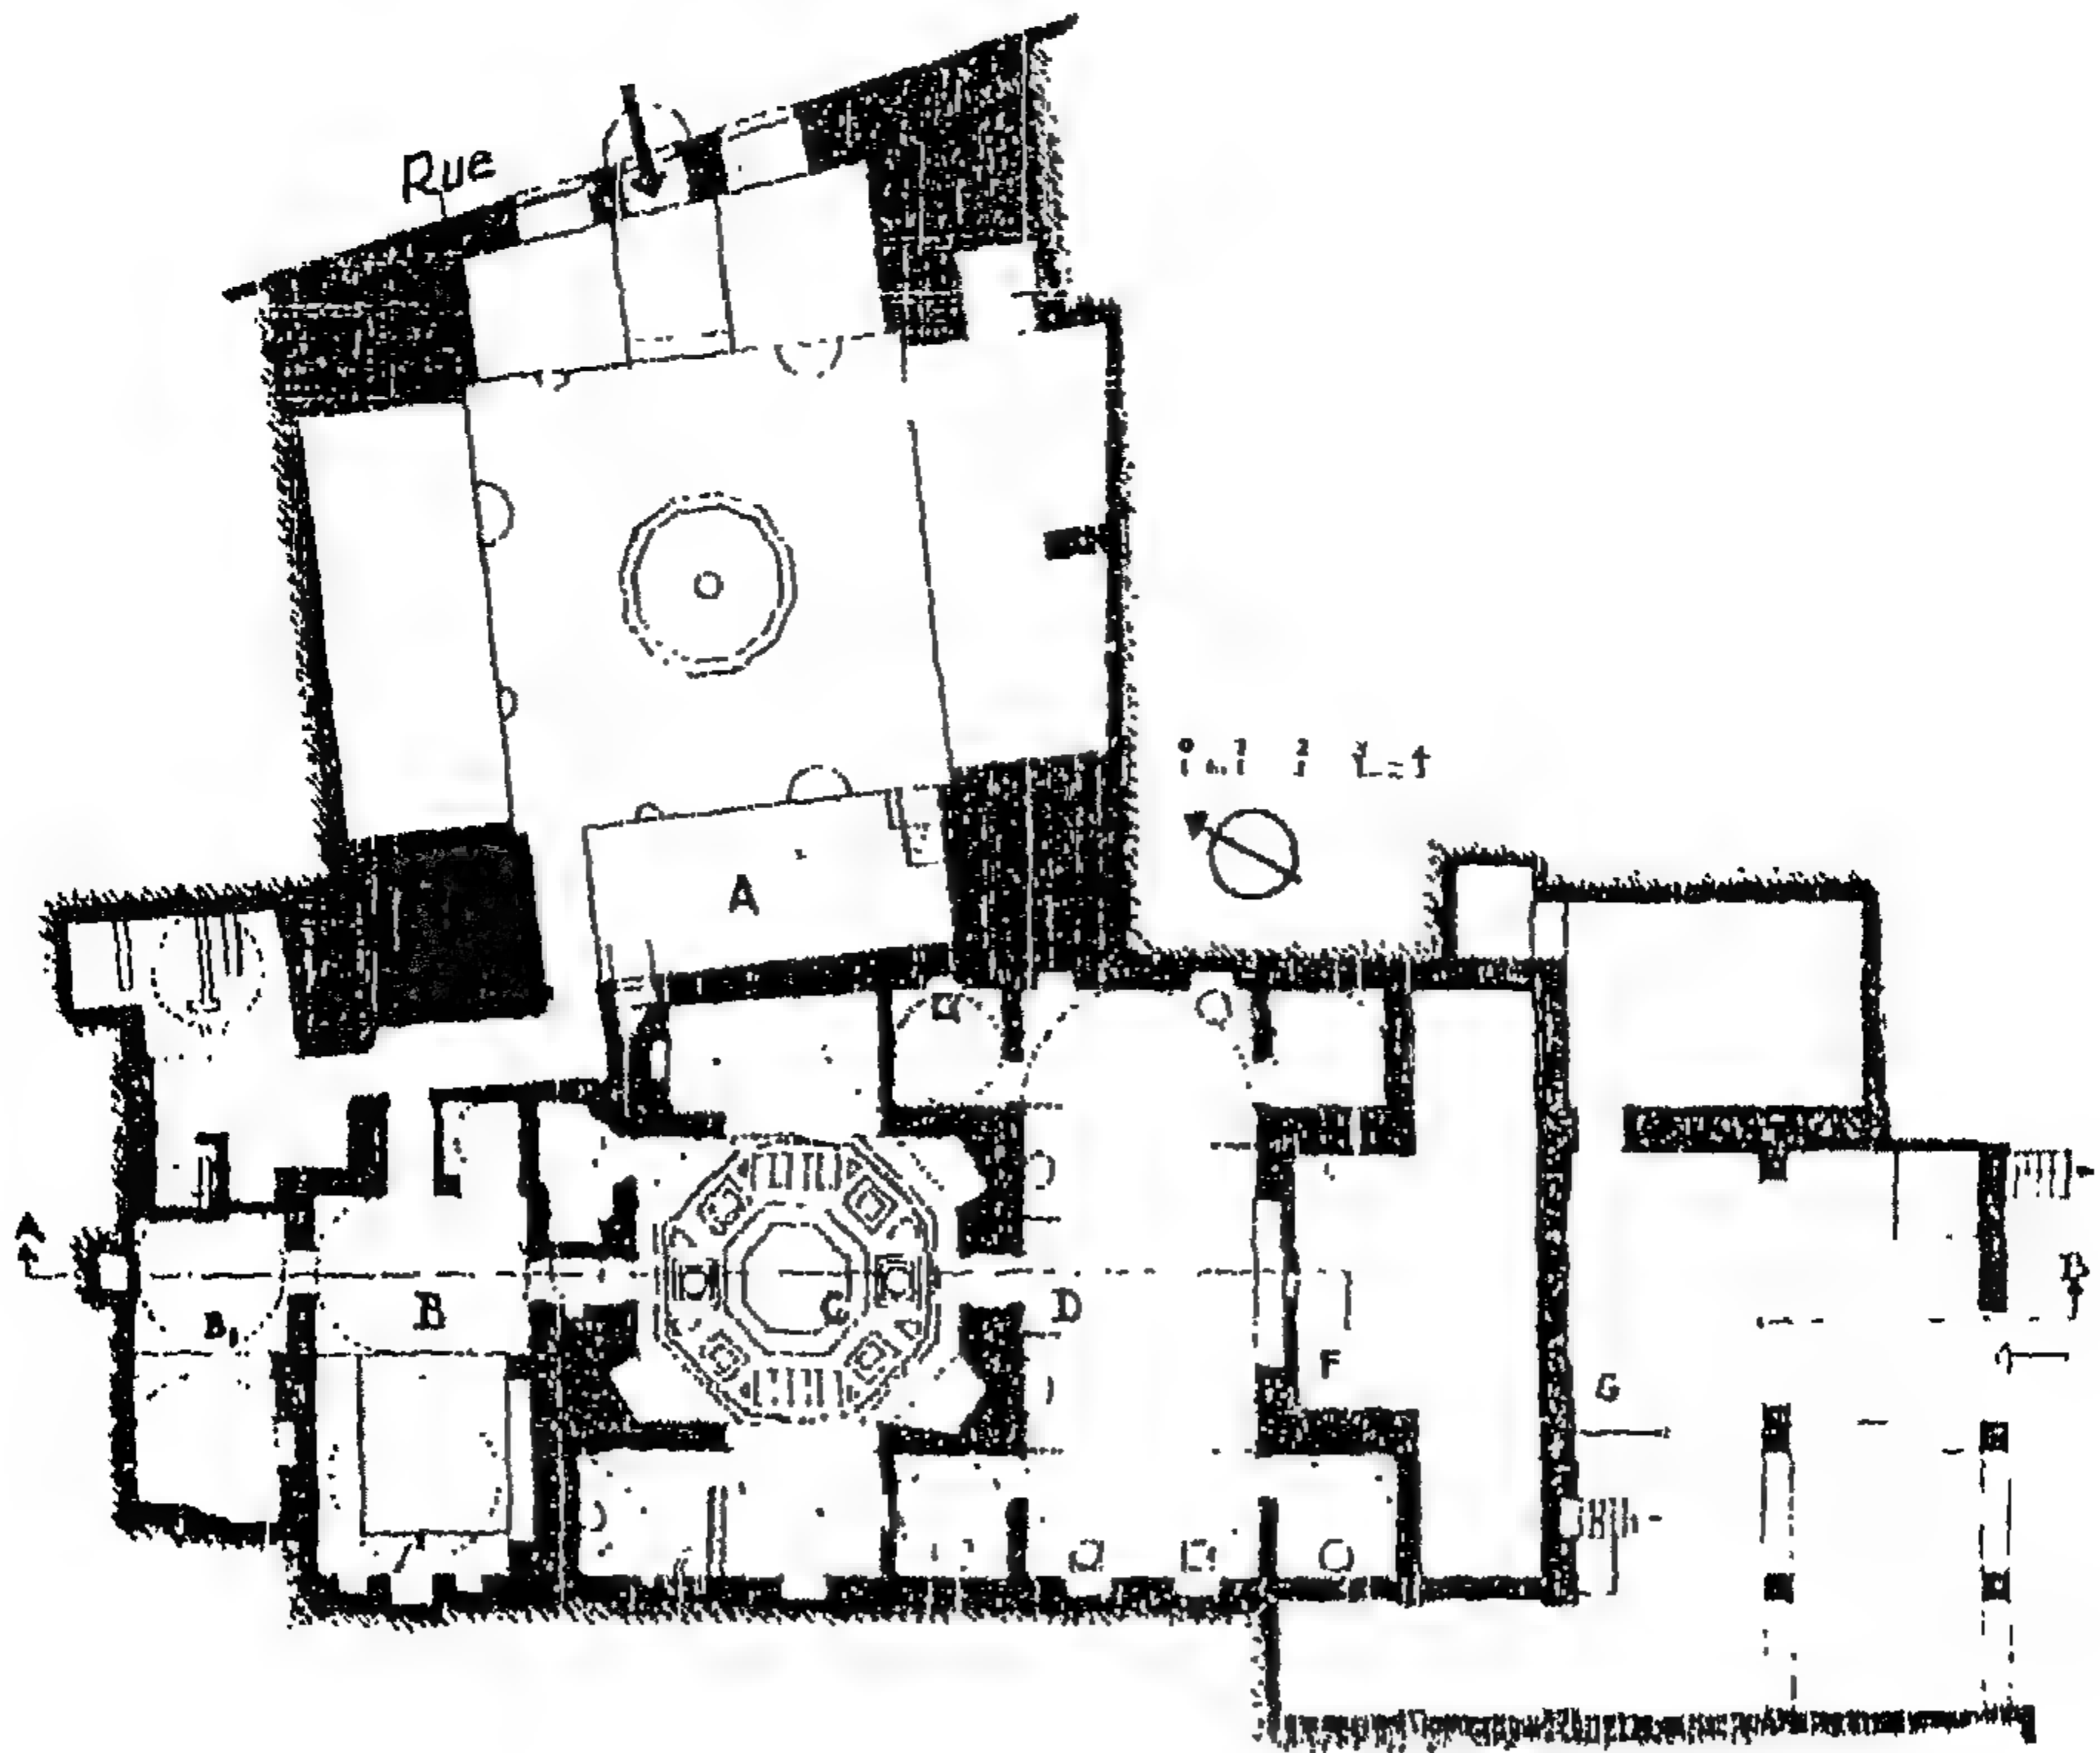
مسقط أفقي لقصر العظم في دمشق.
